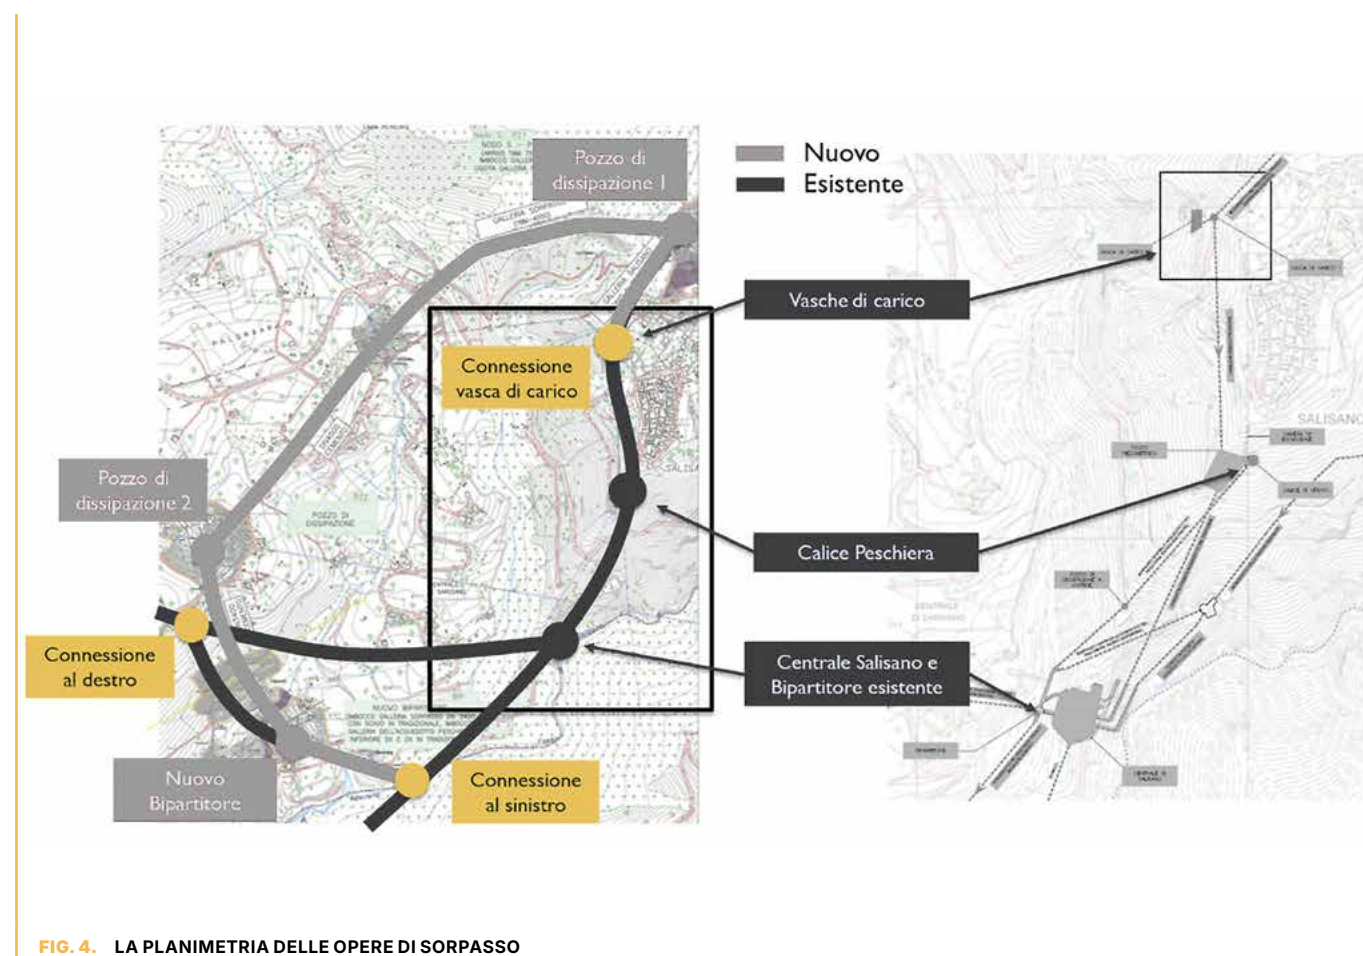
LA PLANIMETRIA DELLE OPERE DI SORPASSO
